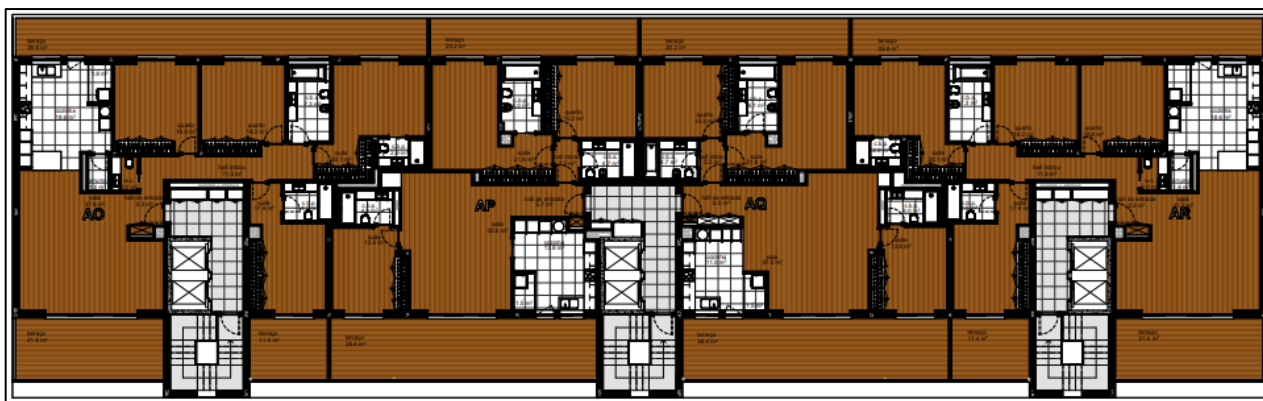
Recorte da planta de arquitetura do piso 5 do edifício Altavista 17 (1).
